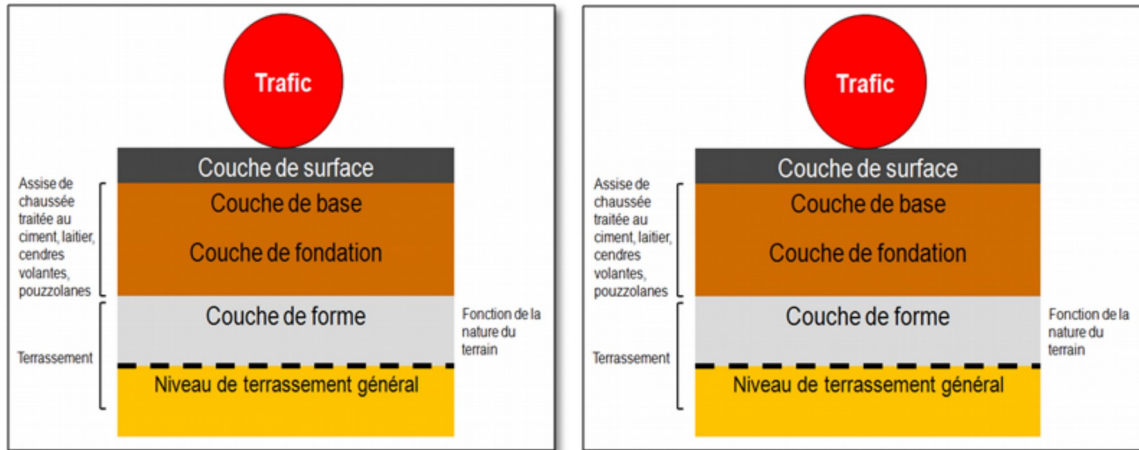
Structure type d'une chaussée semi-rigide.
